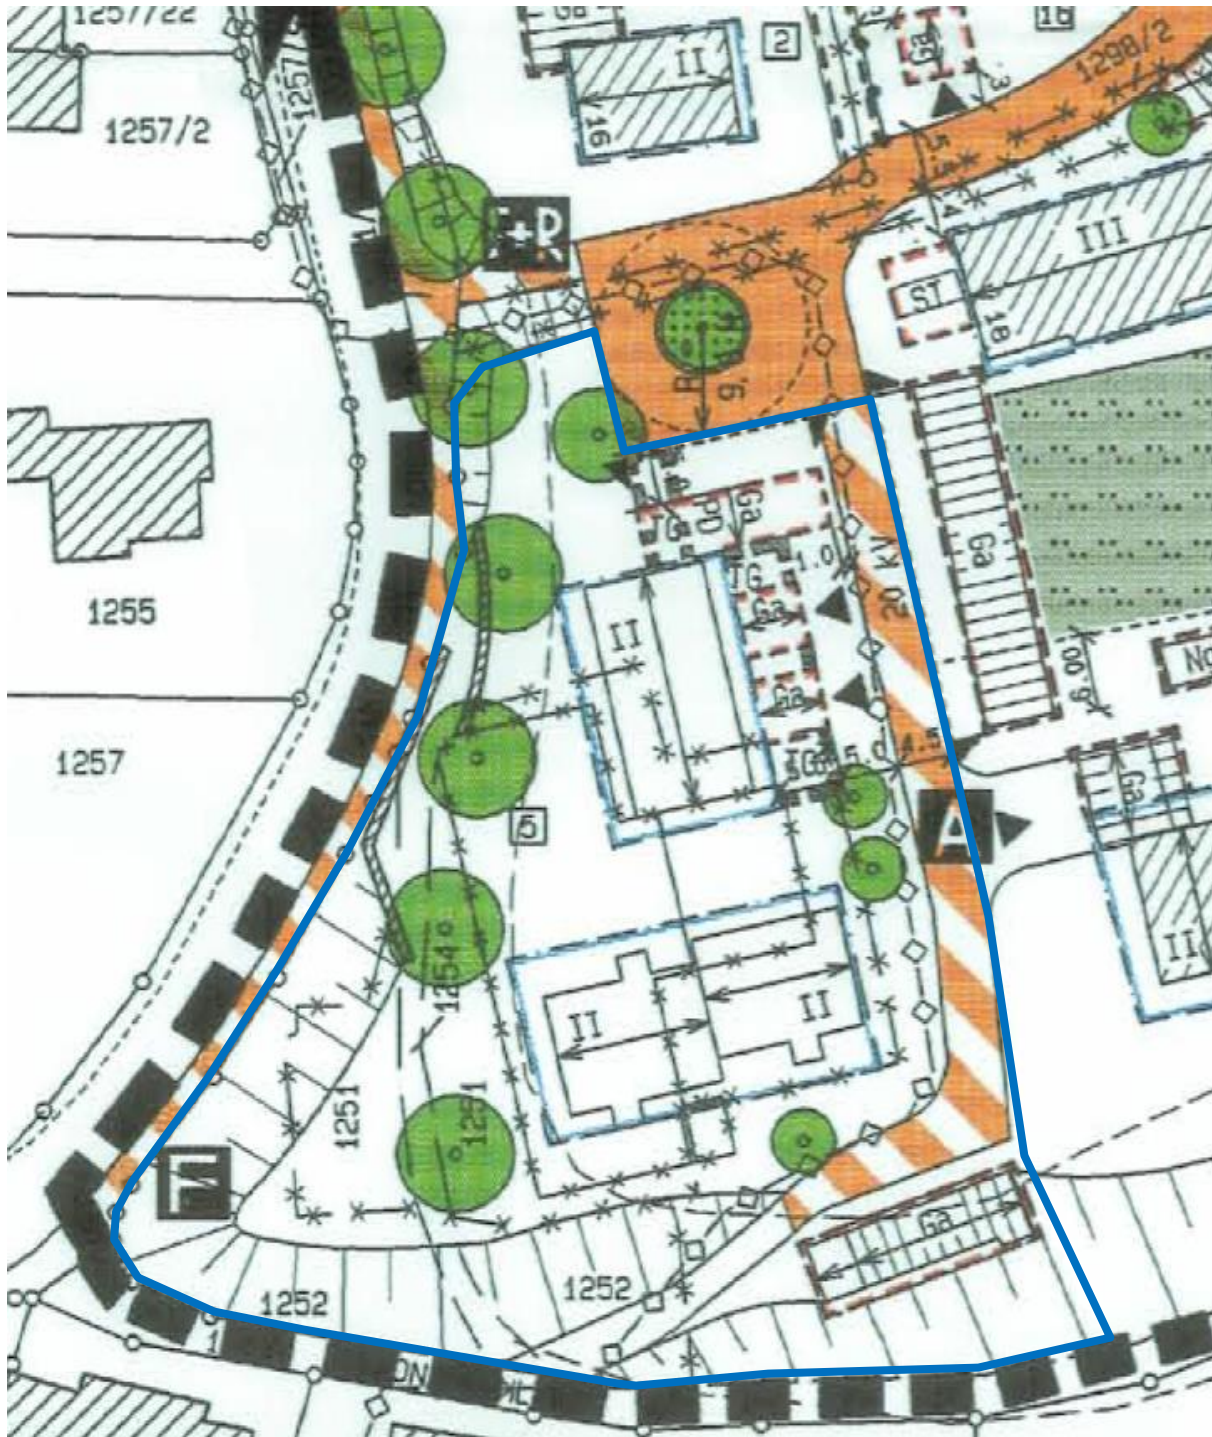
Auszug Bebauungsplan Hallabruck Vorderfeld mit Geltungsbereich, Quelle: Gemeinde Surberg
